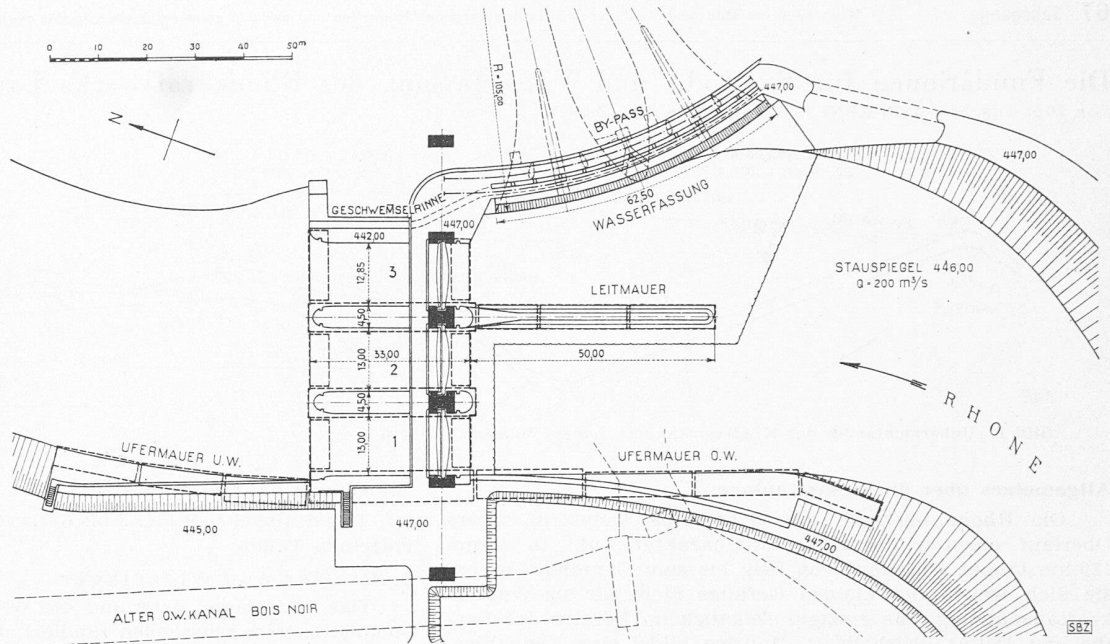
Kraftwerk Lavey, Situationsplan von Stauwehr und Wasserfassung, Masstab 1:1500
